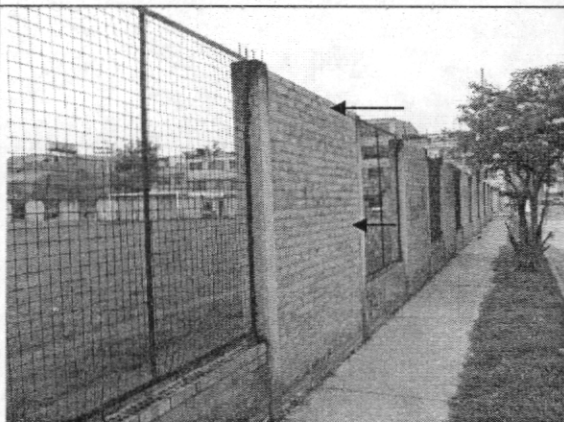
Pérdida de verticalidad, costado Calle 24 A Sur
